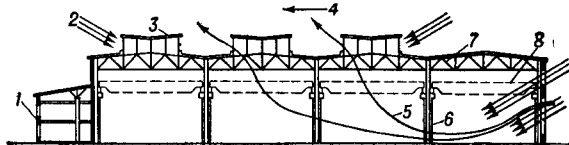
Вертикальный поперечный разрез (схема) одноэтажного многопролётного промышленного здания: 1 — пристройка для бытовых помещений; 2 — направление светового потока; 3 — фонарь верхнего света; 4 — направление ветра; 5 — направление движения воздушных потоков; 6 — стойка; 7 — покрытие; 8 — мостовой кран.
